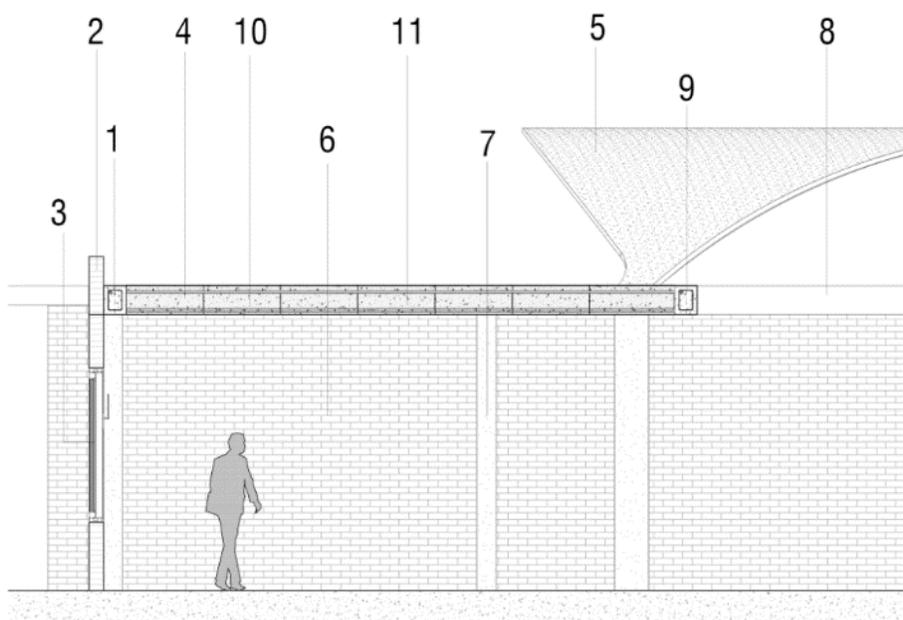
Detalle constructivo entre losa y cubierta Estructura Talleres.
